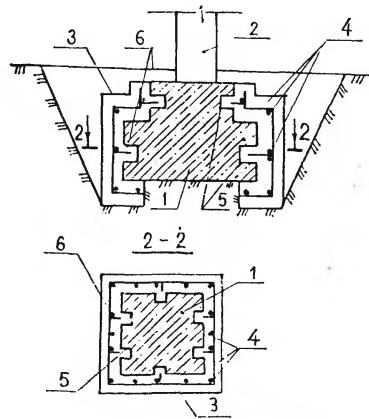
Увеличение опорной площади бетонного столбчатого фундамента
